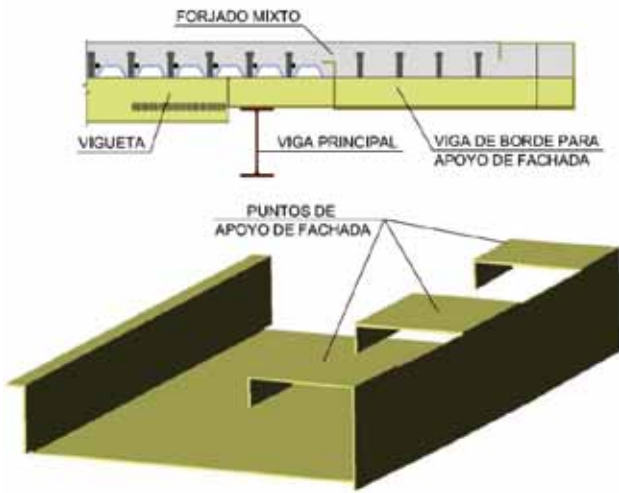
Esquema y vista de la pieza metálica de la viga de borde
